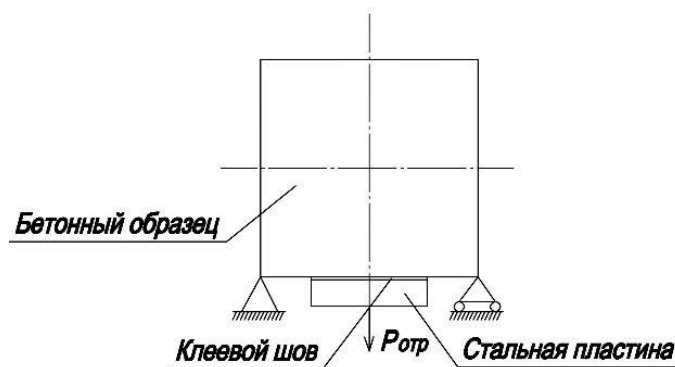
Схема испытания на равномерный отрыв соединения сталь - клей - бетон
